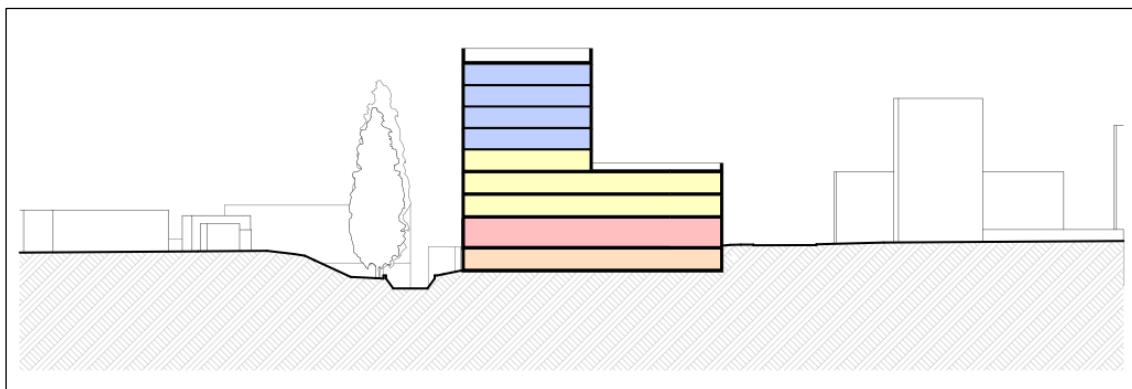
Coupe du bâtiment constructible sur la parcelle n° 3685, affectations prévues par le PA
